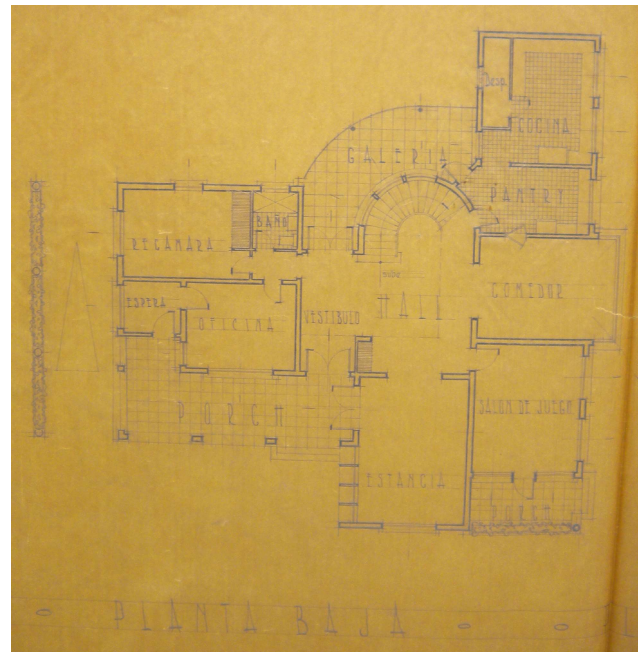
Planta baja del proyecto de Casa habitación para el Sr. Constantino Laborín en la colonia Centenario.
